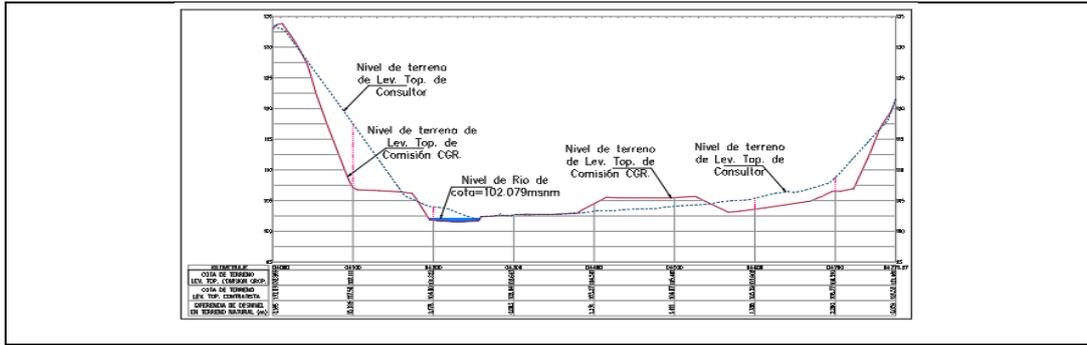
Comparación de perfiles longitudinales de terreno en la sección n.º16 entre levantamiento topográfico GRCP y levantamiento topográfico del Contratista (lámina de plano de Consorcio TS-16).
